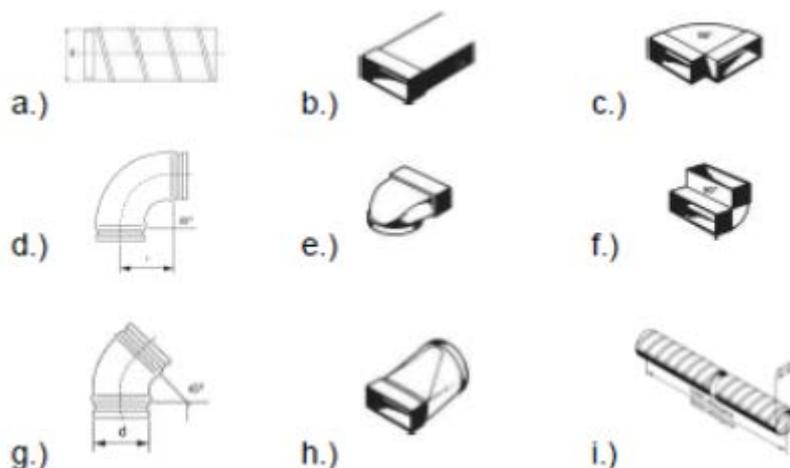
Rappresentazione schematica degli elementi di base del sistema di canalizzazione aria
